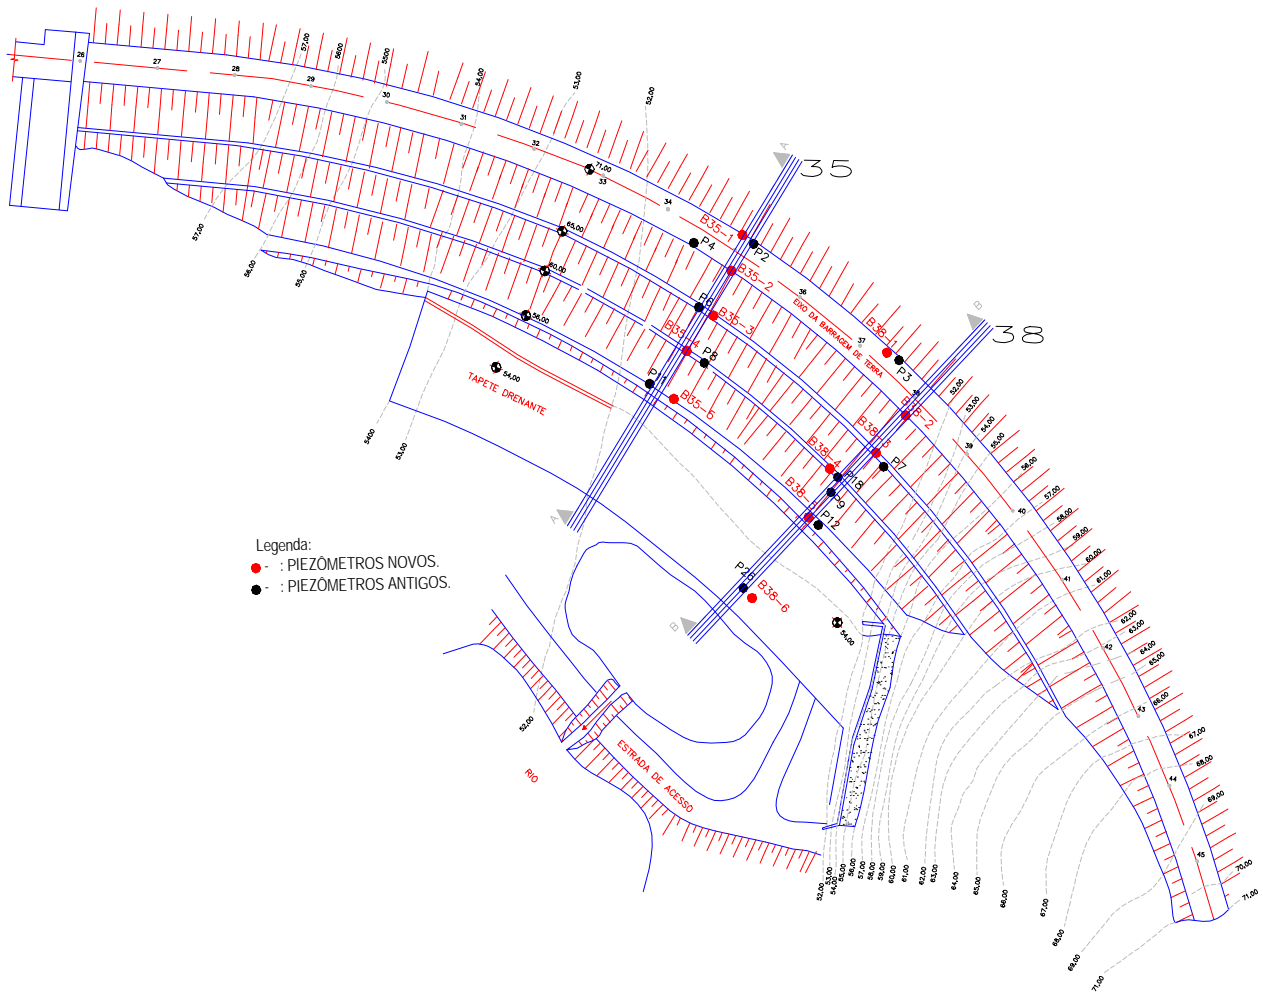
Planta baixa da barragem de terra com as seções instrumentadas
